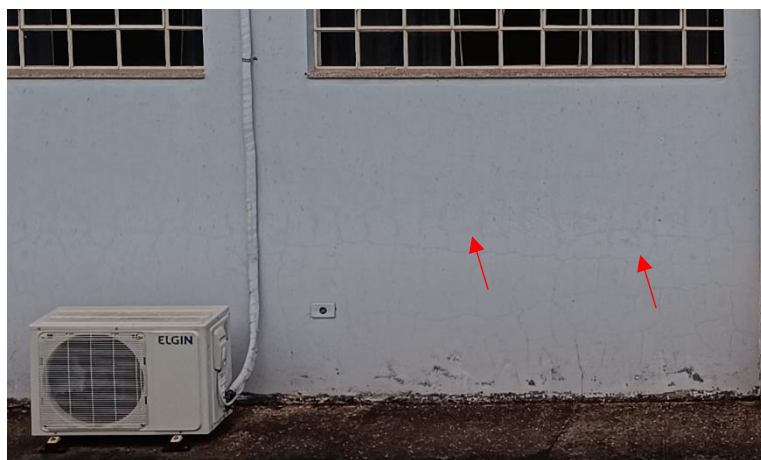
Fissuras sem causa definida pela autora – Fachada J
